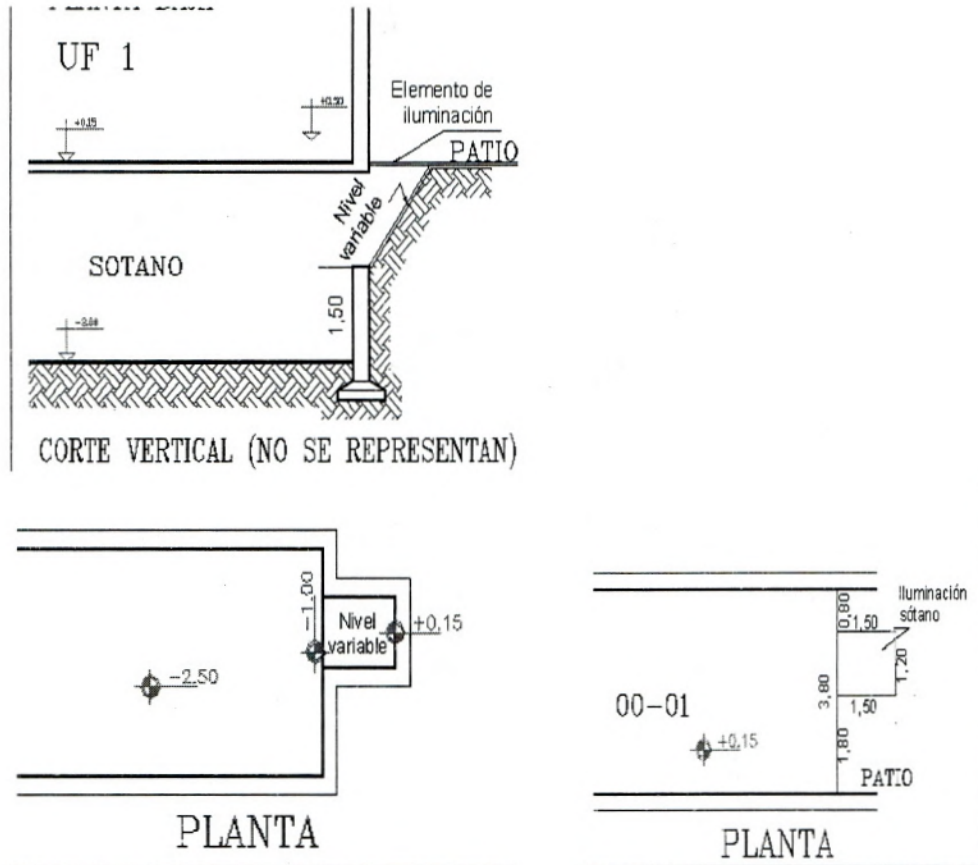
Iluminación con elementos ubicados directamente sobre el local
